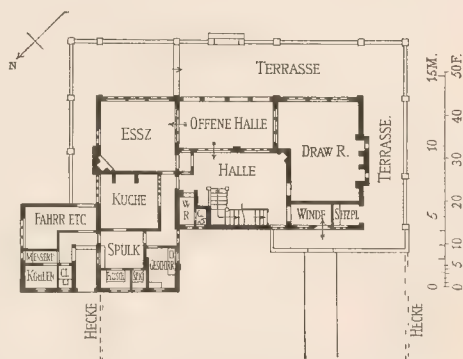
Haus Warren Mount in Oxshott, Surrey. Erdgeschoß. Erbaut von Walter Cave. 1:400.
